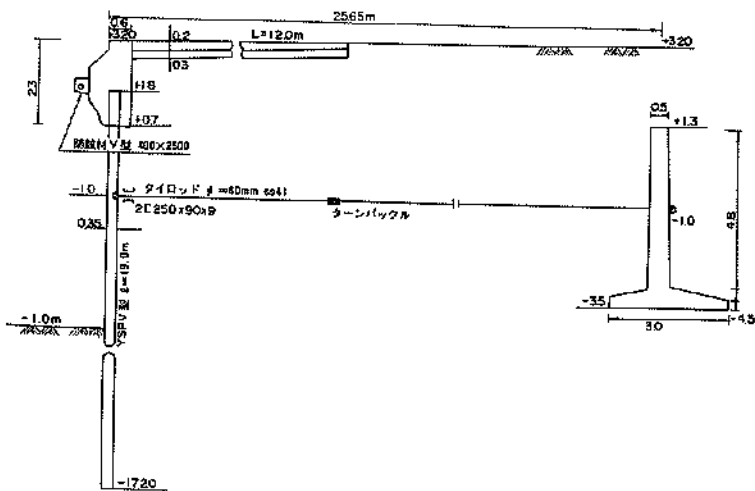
標準断面図 (中央埠頭地区, ⑥岸壁(-10.0m))
